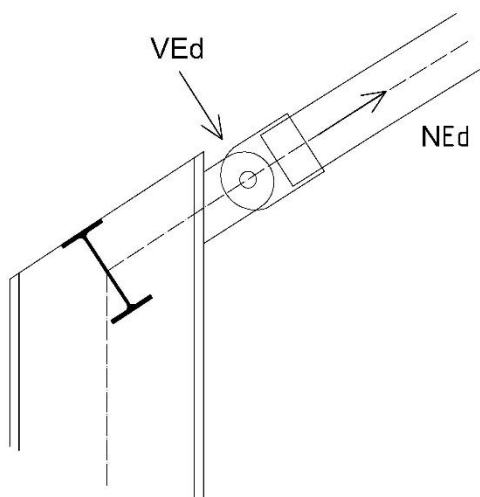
Prehľad detailov riešených v statickom výpočte
